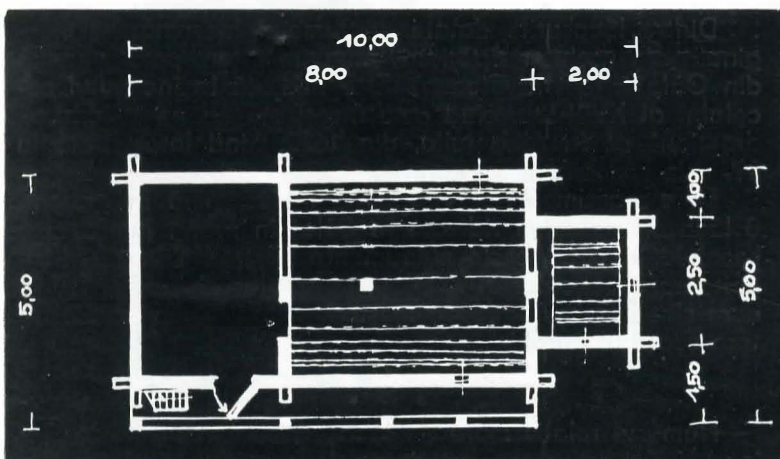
Biserica din Sighetul Silvaniei, plan.
